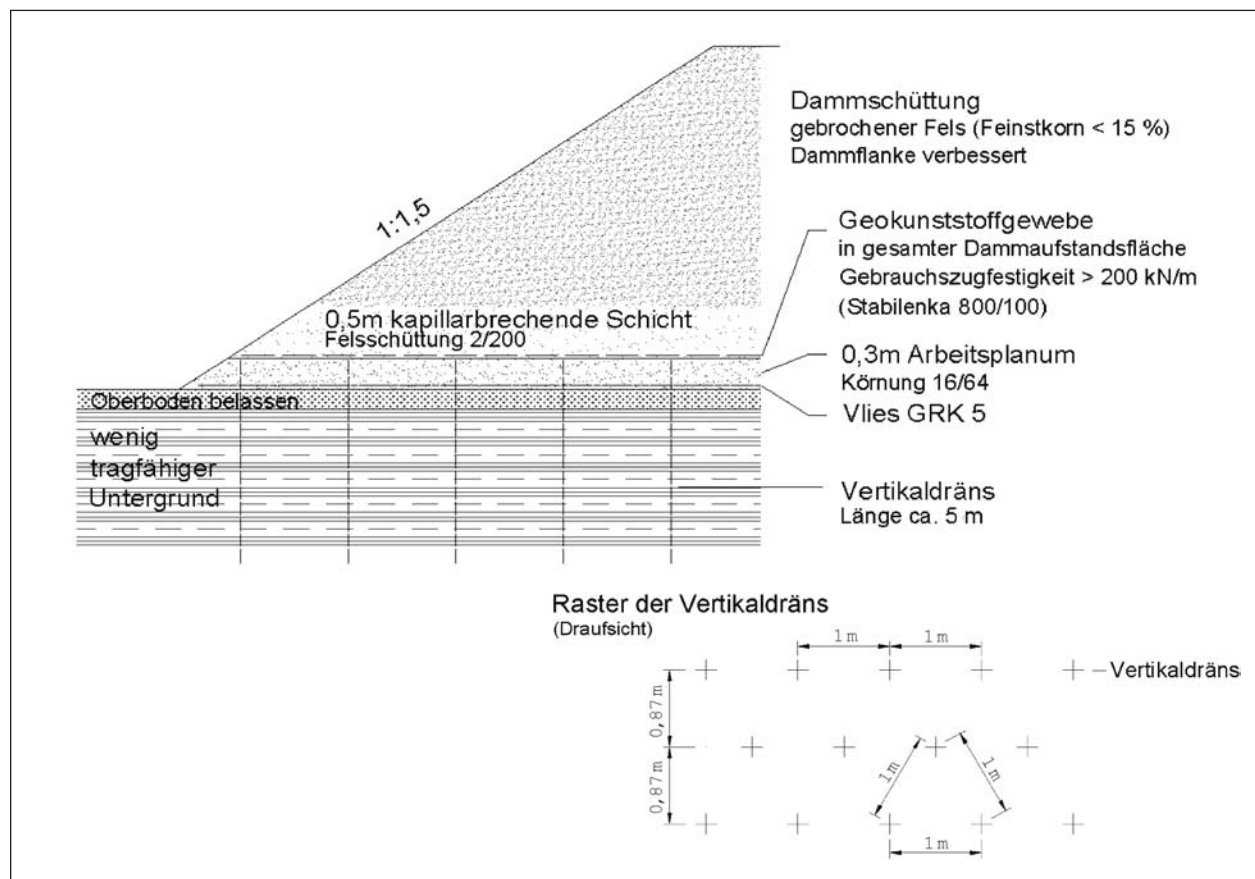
Dammbaufbau mit Vertikaldräns und Geokunststoffbewehrung
